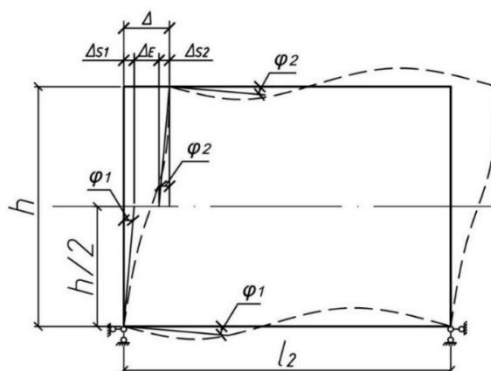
Схема рамы с податливыми узлами к определению горизонтальных перемещений
